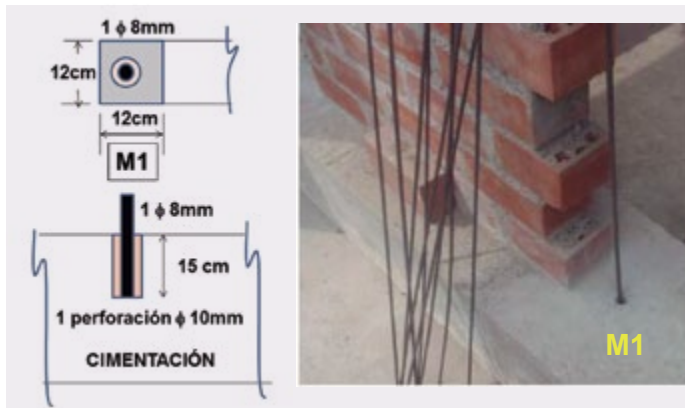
Refuerzo y anclaje en columnas del parapeto M1.
